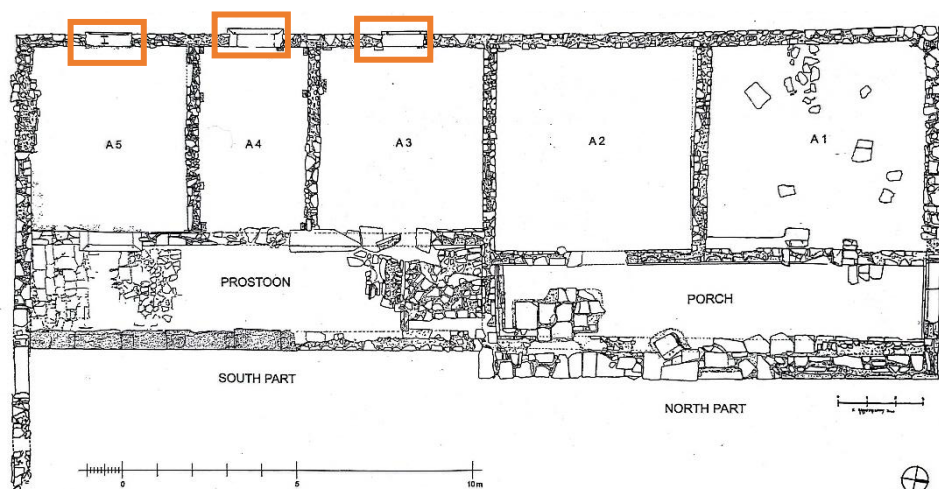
Pianta dell'edificio A con porte ad ovest evidenziate
